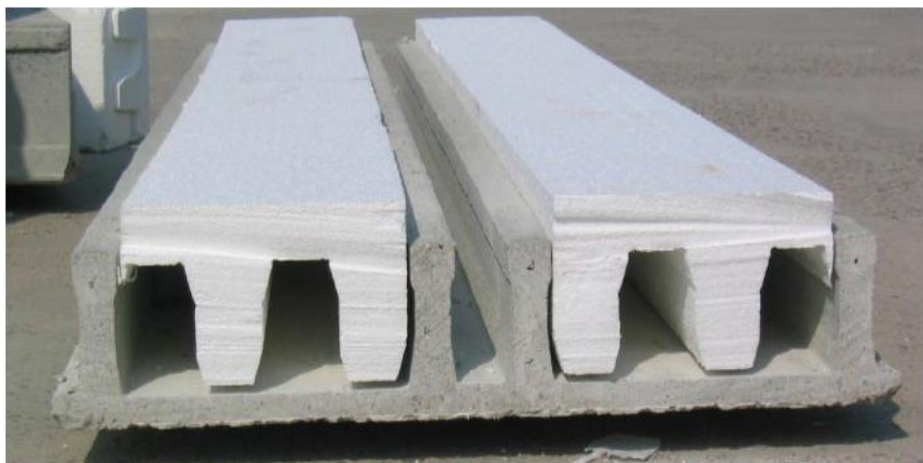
Prancha prefabricada alveolada montada em obra (Albarram, 2008).
